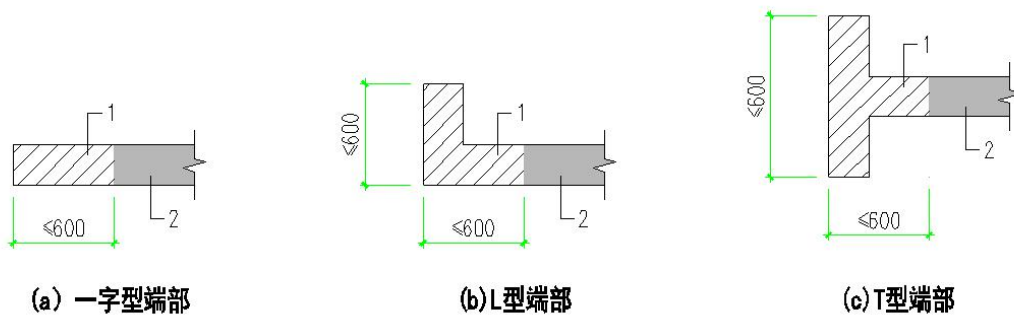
预制剪力墙端部竖向现浇段示意（尺寸单位：mm）
